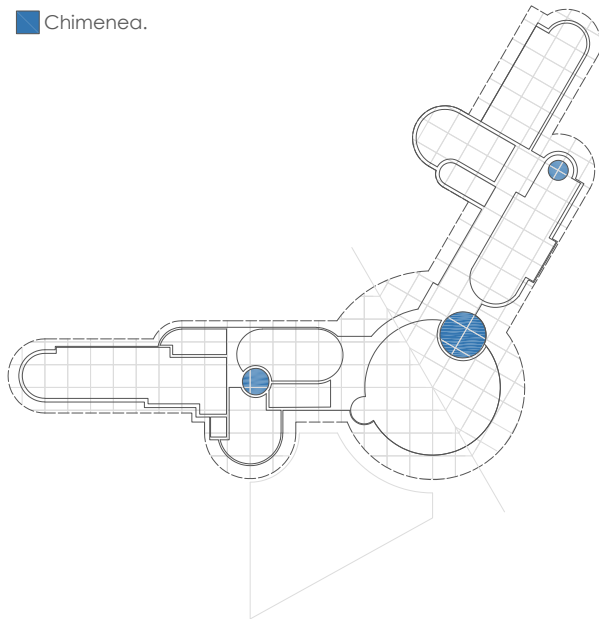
Diagrama de chimeneas en planta. Realizado por la autora.
